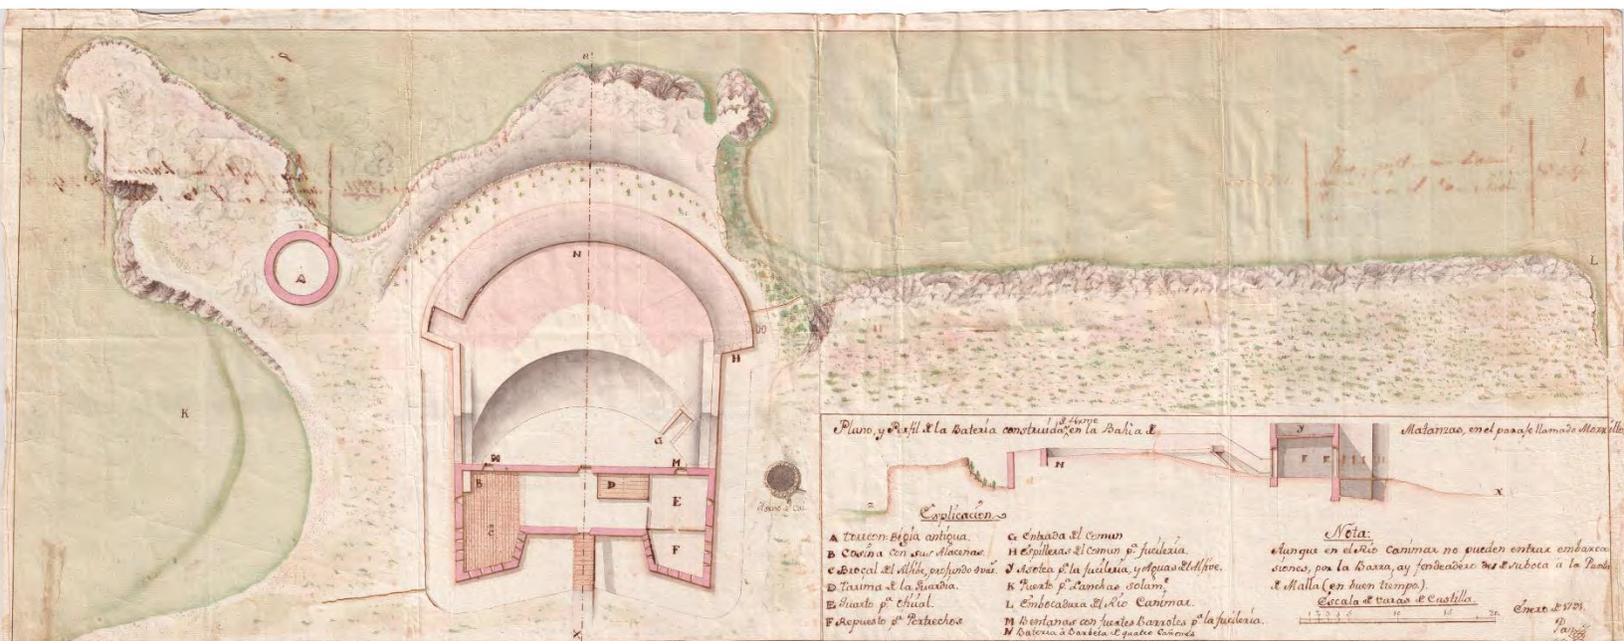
Plano y perfil de la batería construida de firme en la bahía de Matanzas, en el paraje llamado Morrillo firmado por Felipe Paz. S. Caraviella, enero de 1791 (AGMM: CUB-94-06).
